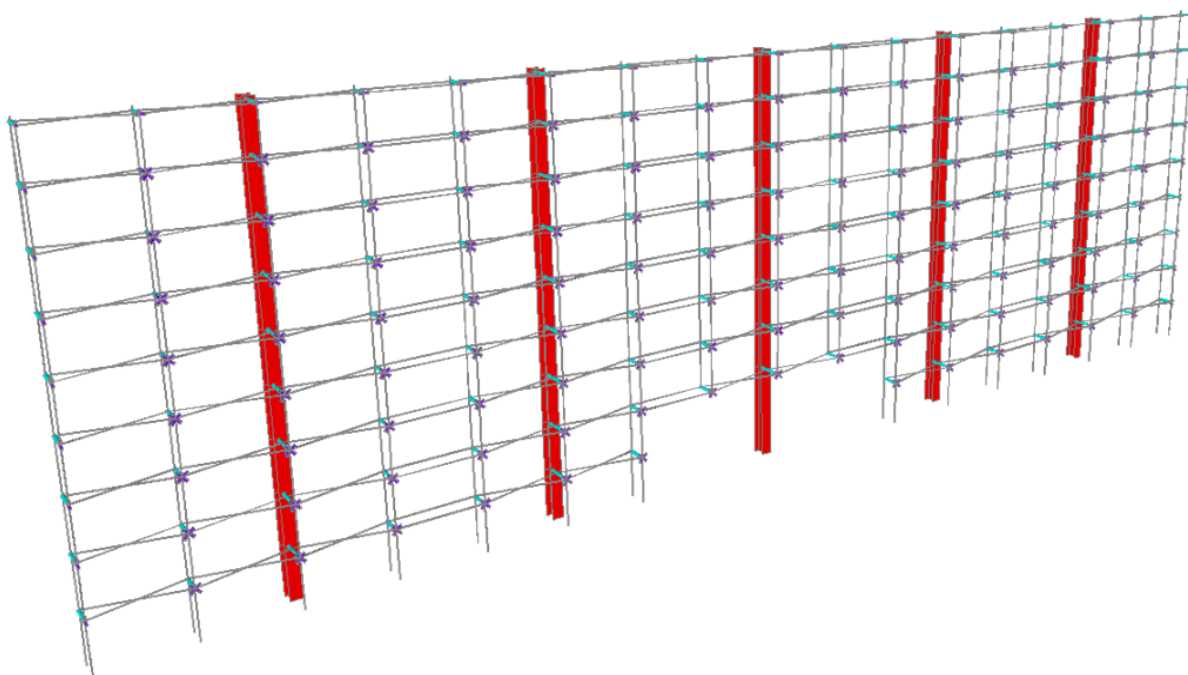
Modelo tridimensional da fachada sem os painéis de vidro.
